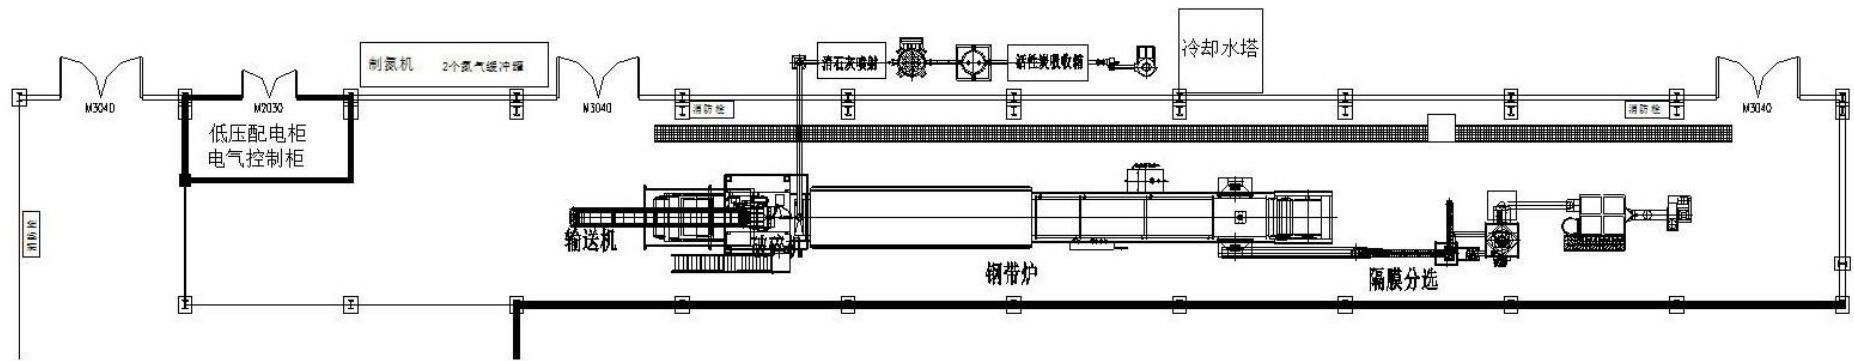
项目带电电池破碎分选中试线平面布置示意图
